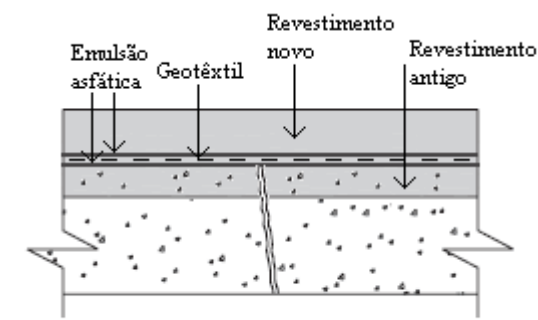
Perfil de pavimento com aplicação de geotêxtil
